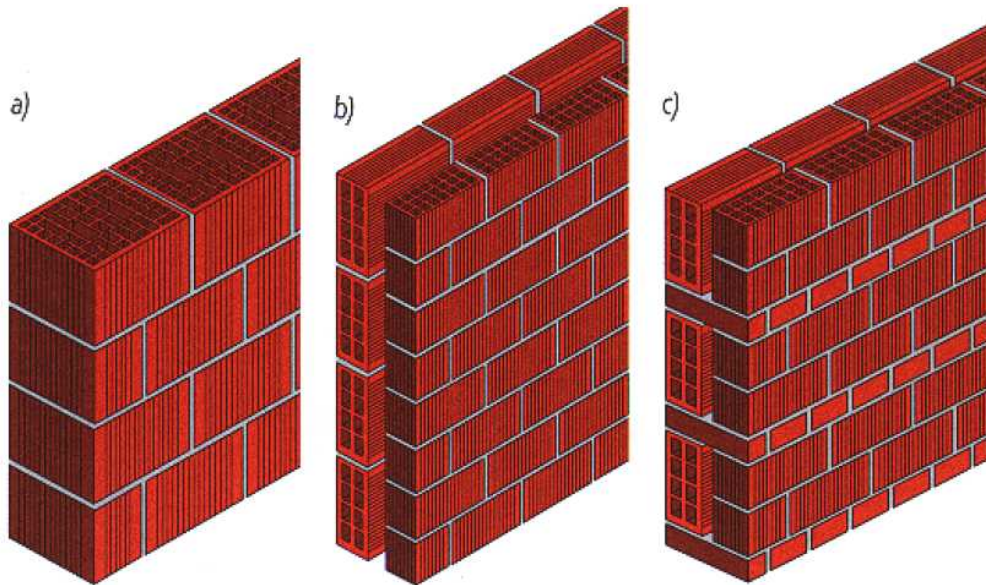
Esempio di murature: muratura monostrato (a); muratura a doppio strato (b); muratura mista (c).
